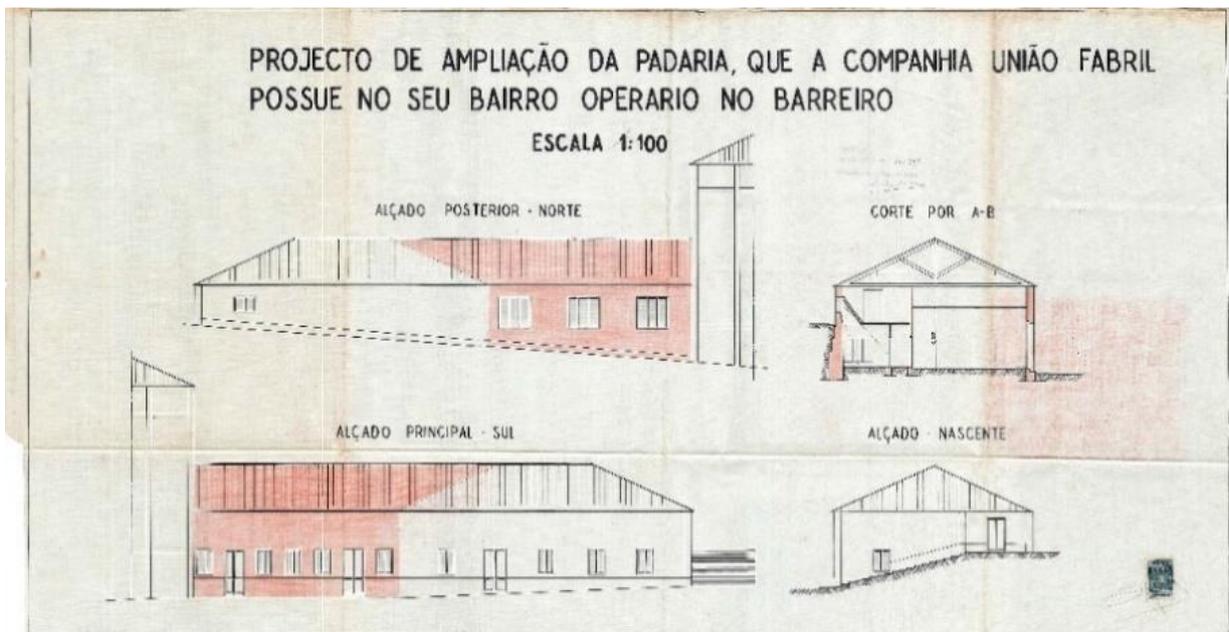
Conjunto de Alçados e Corte do projeto de ampliação da Padaria que a CUF possui no Bairro Operário.
